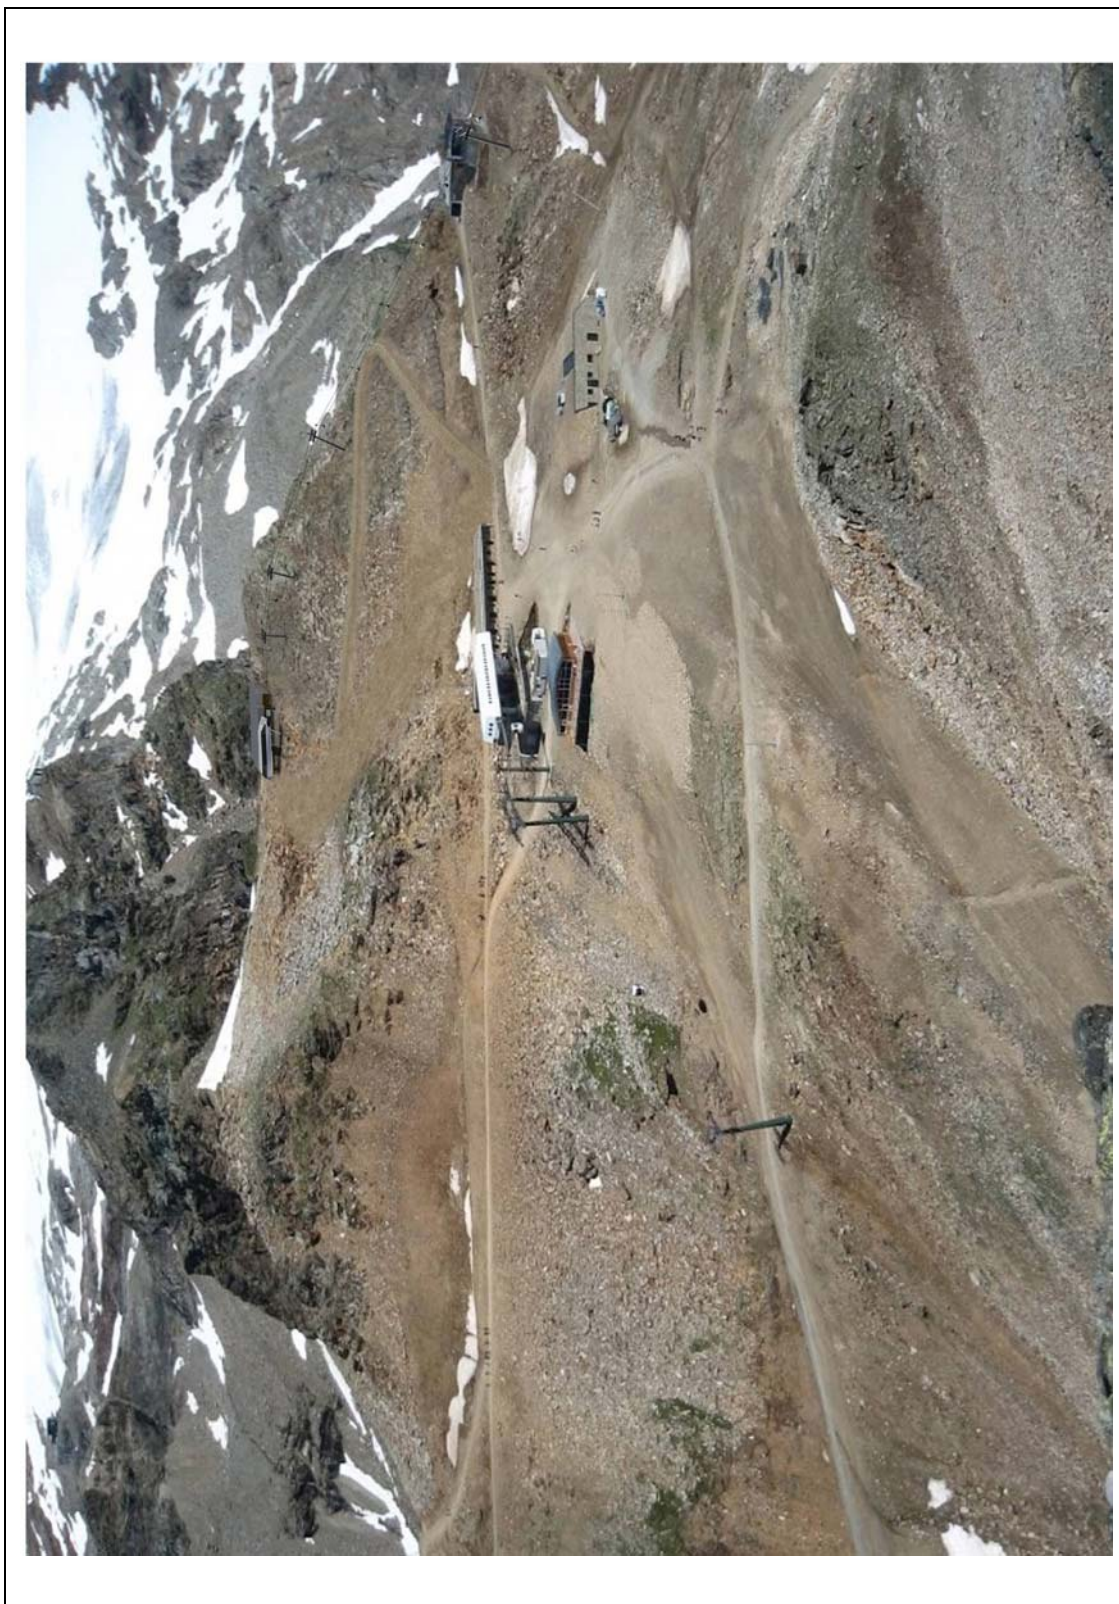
/5 Fotoinserimento della stazione di monte - Panoramica dal Corno Rosso
